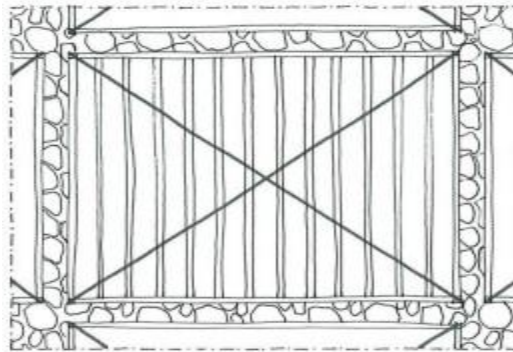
Reforço do pavimento com tirantes metálicos (Costa, 2009).
